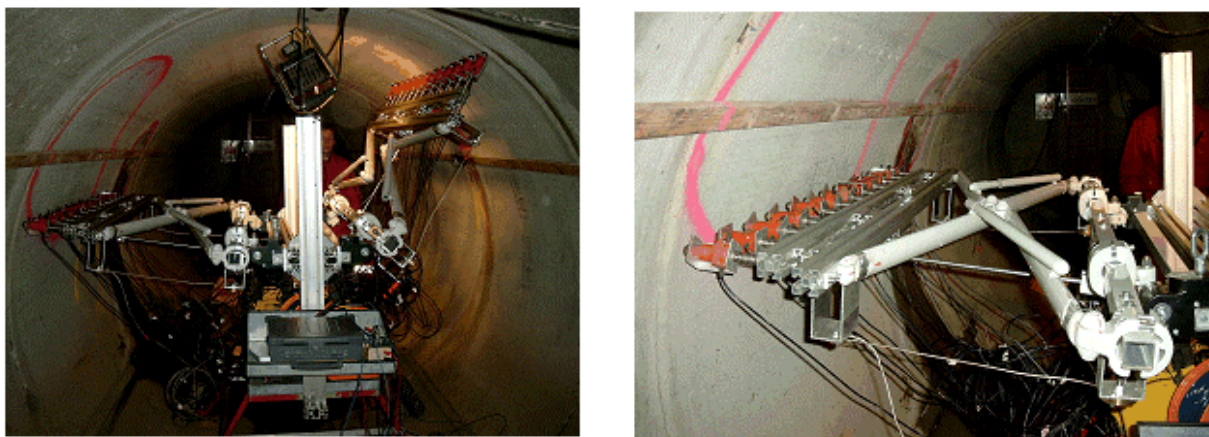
Prototyp des Kanalmesswagens, konstruiert auf Grundlage der in der Testhaltung in Köln gewonnenen Erfahrungen, zur Durchführung routinemäßiger Kanalerkundungen
